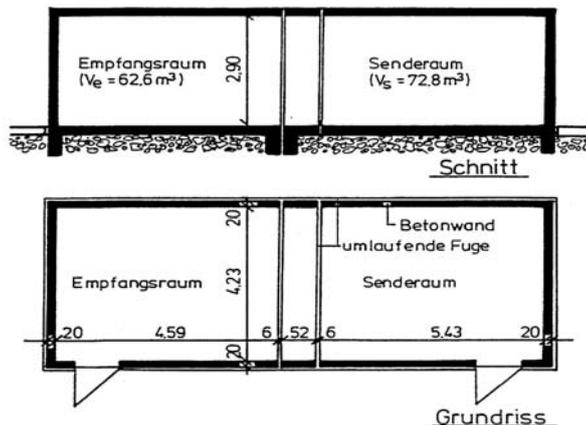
Grundriss und Schnitt des Prüfraums
